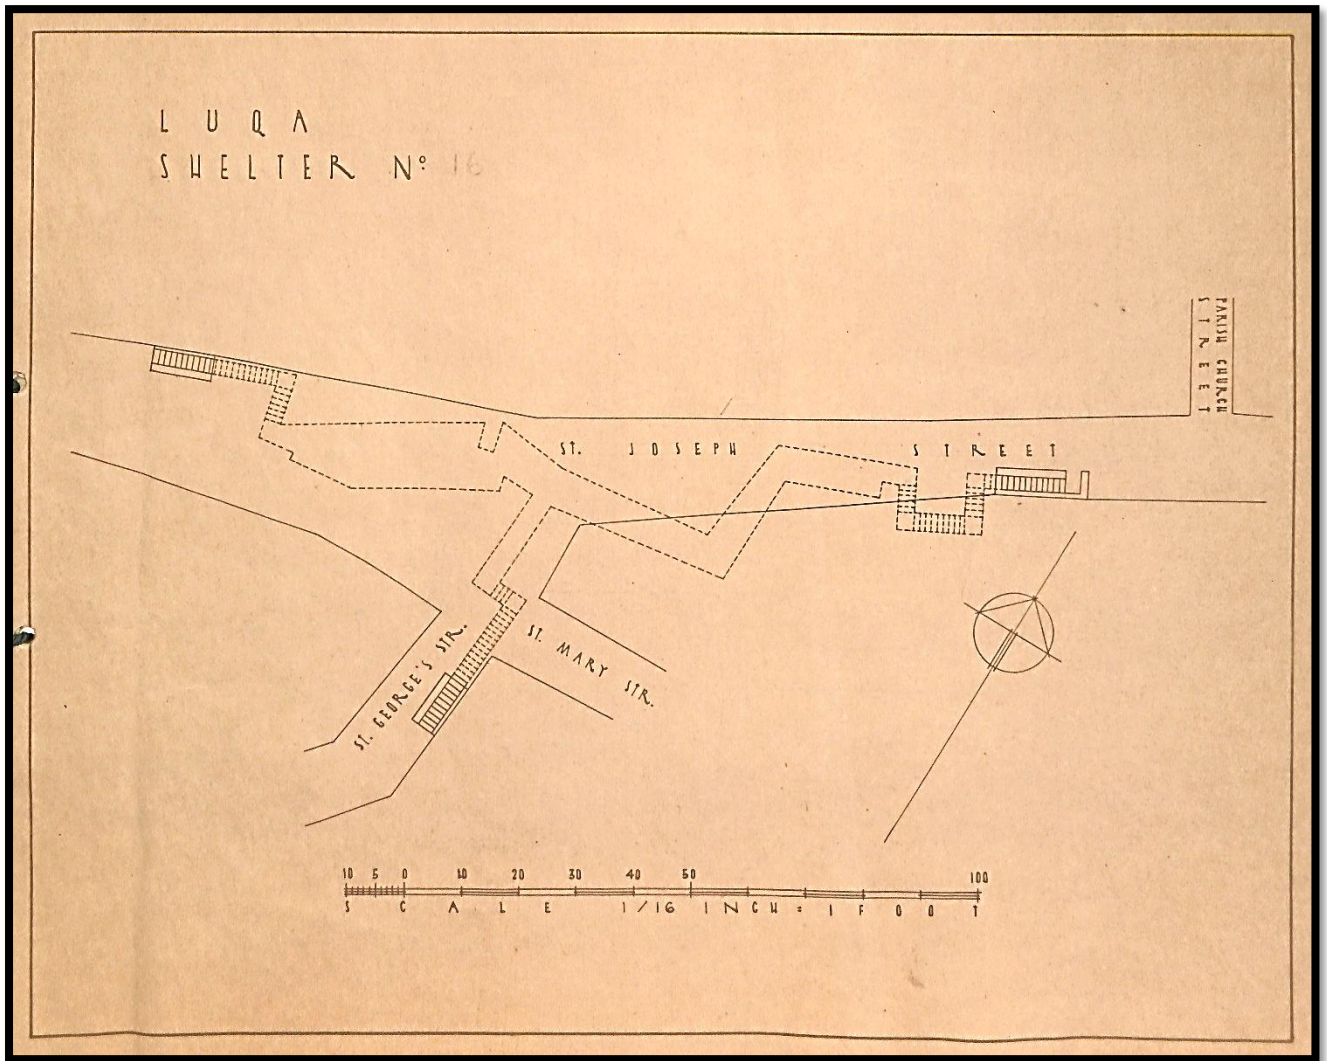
Planta do Abrigo nº16 "St. Joseph Street – St. George's Street – St. Mary Str – Parish Church Street"
